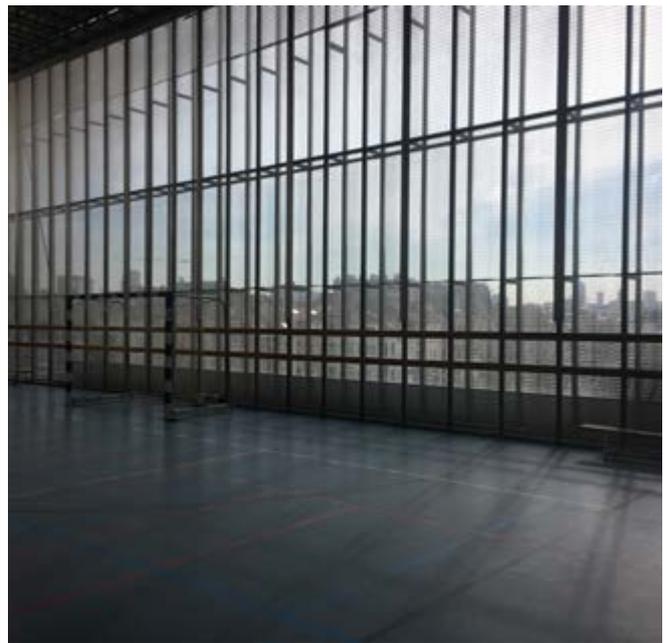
Mur-rideau en verre de la salle de mini-foot
